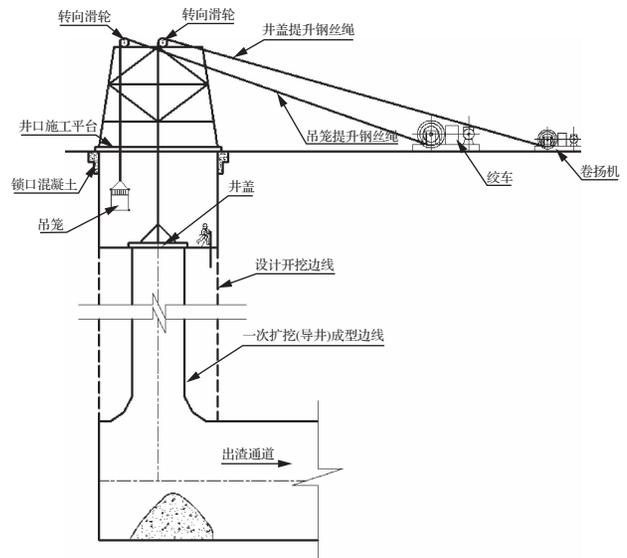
竖井全断面开挖支护施工(提升系统布置)示意图
